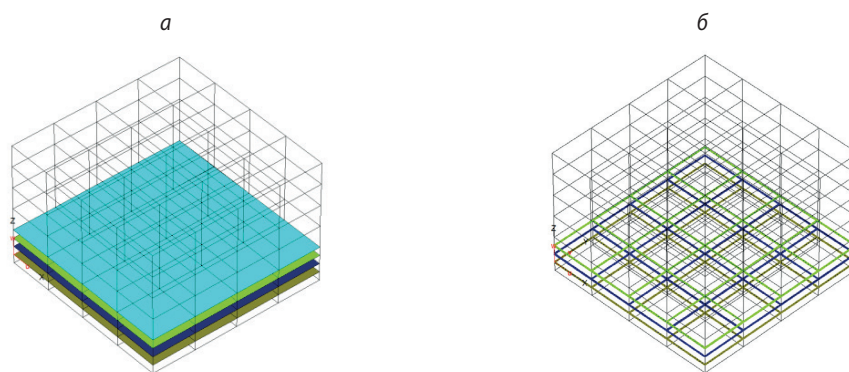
Примеры моделирования армирования толстых фундаментных плит из объемных конечных элементов: *а* — моделирование плоскими элементами; *б* — моделирование стержневыми элементами
